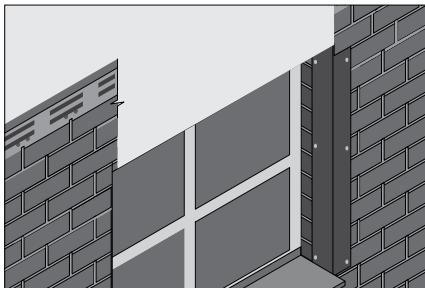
Монтаж бокового наличника (верхний край заходит под фасадную плитку)
